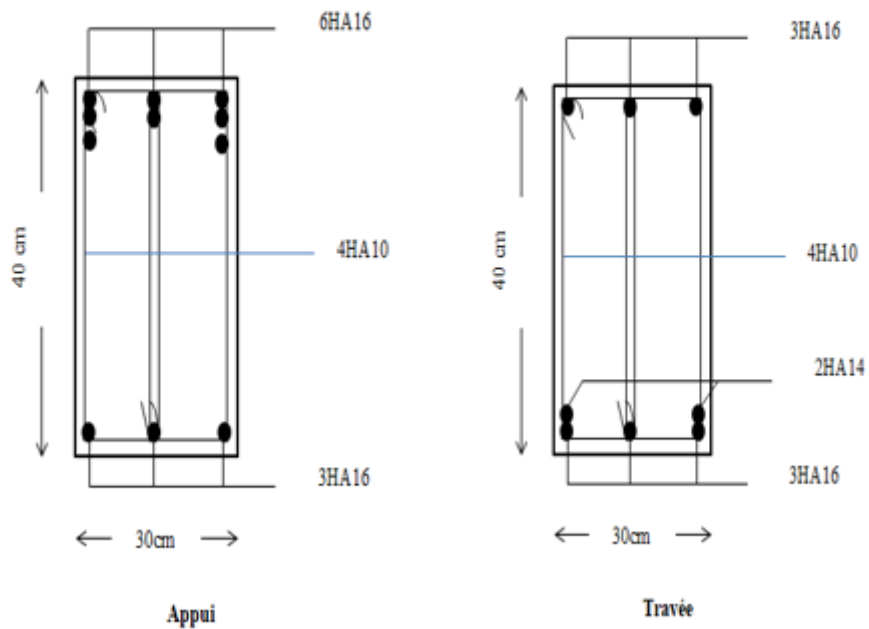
Schéma de ferrailage des poutres non porteuses du (RDC au 6^{ème}) étage.
